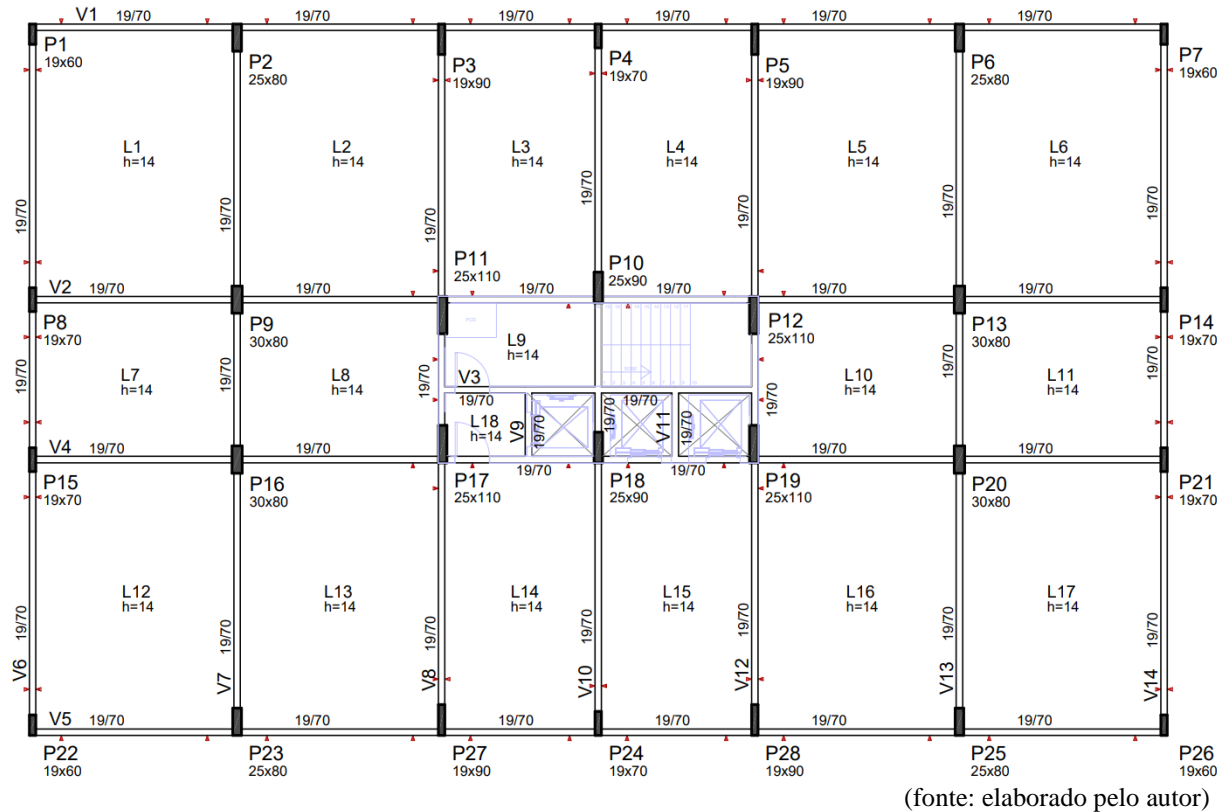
planta de fôrmas do 17º ao 20º pavimento - Tipo 7
